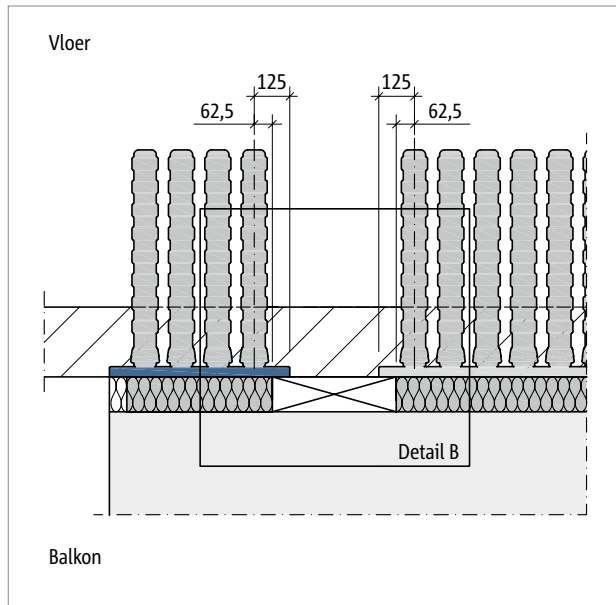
Schöck Isokorf® XT type K-E: detail A, juist door naleving van de rastermaat en de voorgeschreven afstanden
